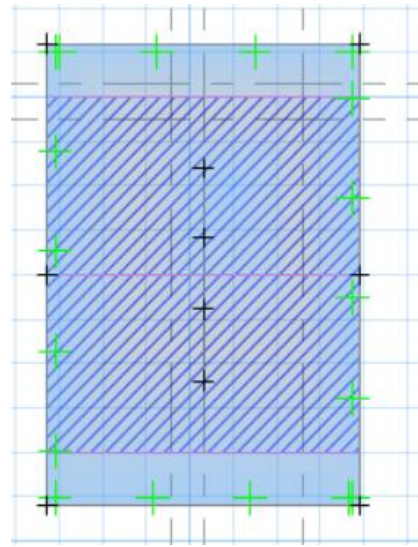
Design Strip en fundación con dirección transversal (Strip Layer B).
